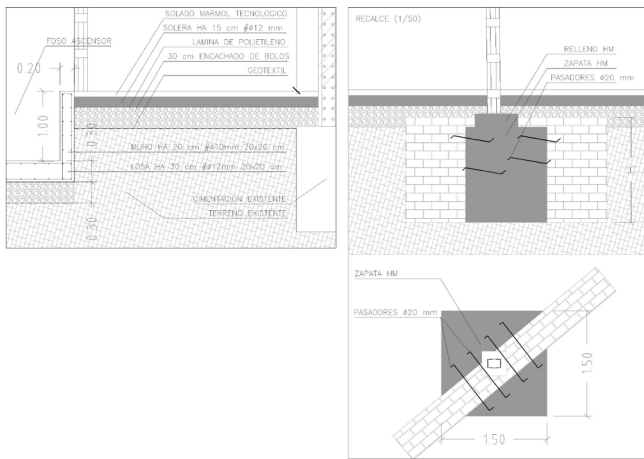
Detalles de solera arriostrante y recalce en zapata.
